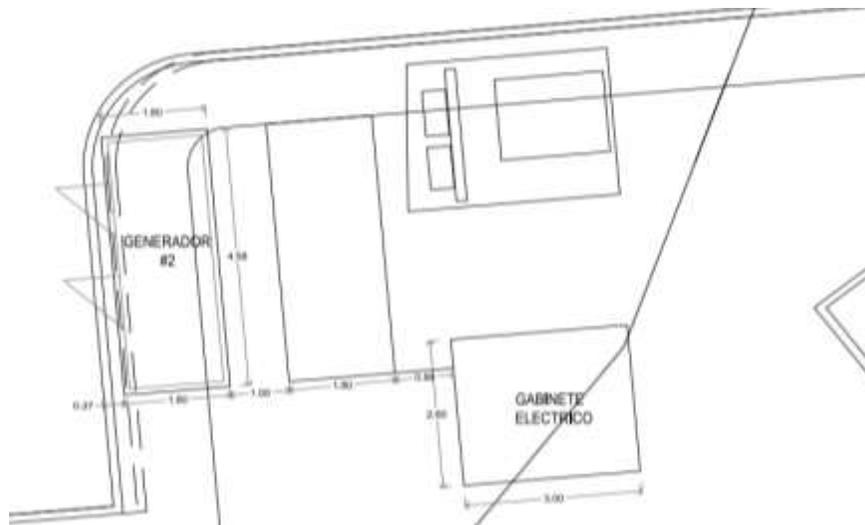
Planta Arquitectónica Generadores Torre GK
